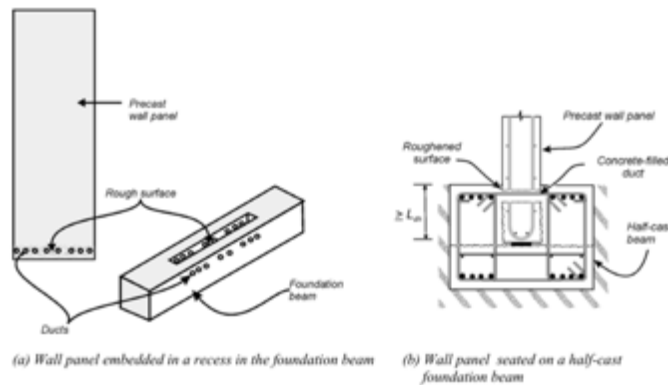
Conexión viga de fundación-muro (fib, 2003).
